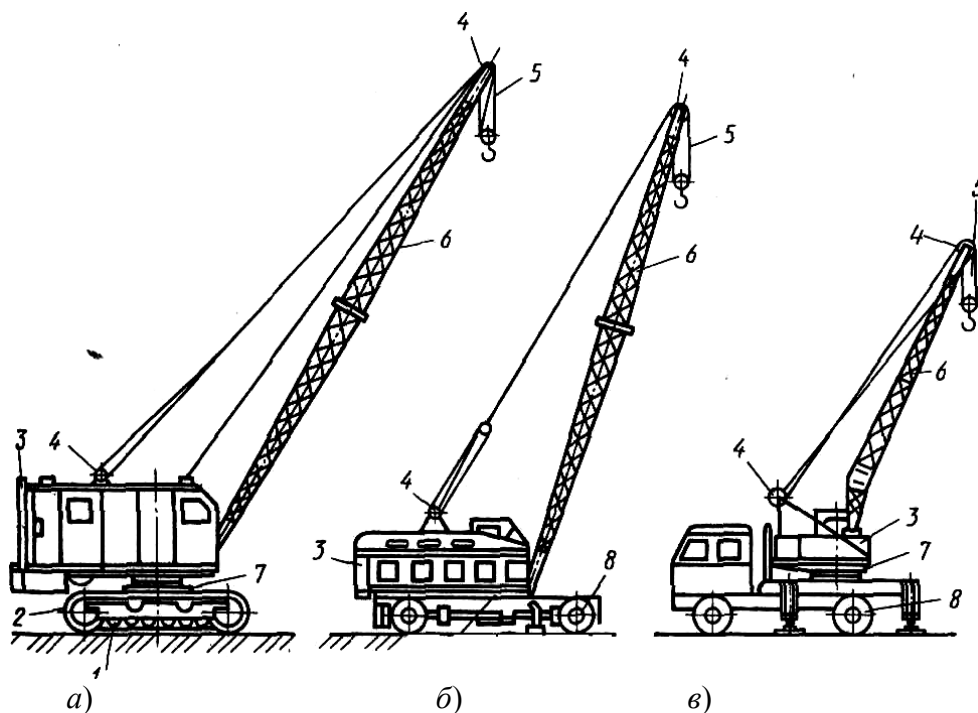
Самоходные стреловые краны: *а* – на гусеничном ходу; *б* – на пневмоколесном ходу; *в* – автомобильный; 1 – опорный каток; 2 – гусеница; 3 – поворотная платформа; 4 – блок; 5 – канат; 6 – стрела; 7 – поворотное устройство; 8 – пневматическая шина
